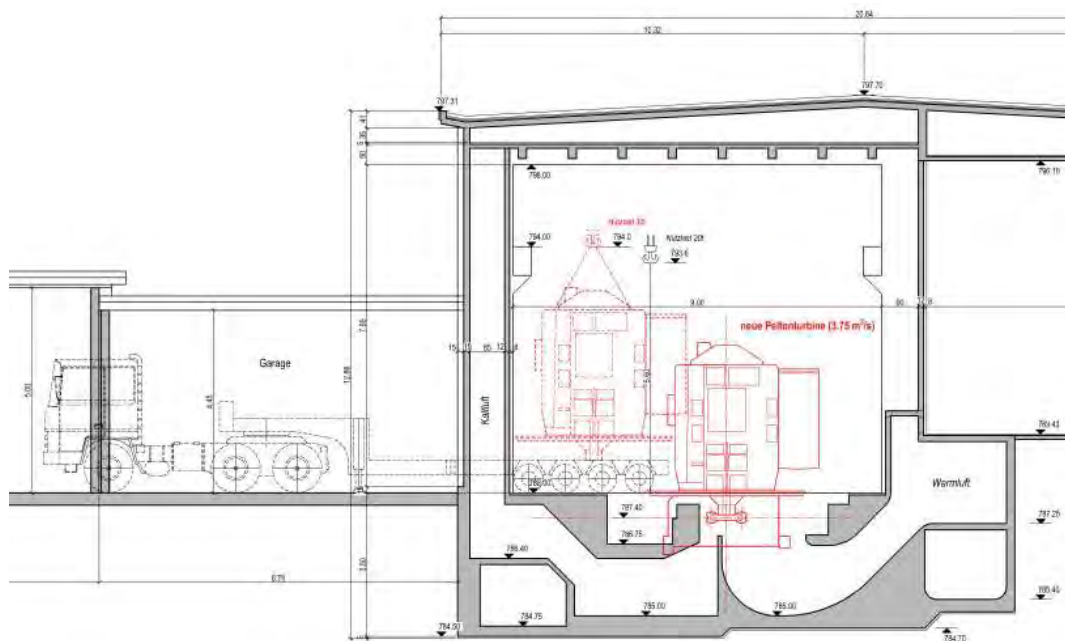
Schnitt der geplanten Erweiterung des Maschinenhaus Bisisthal.
